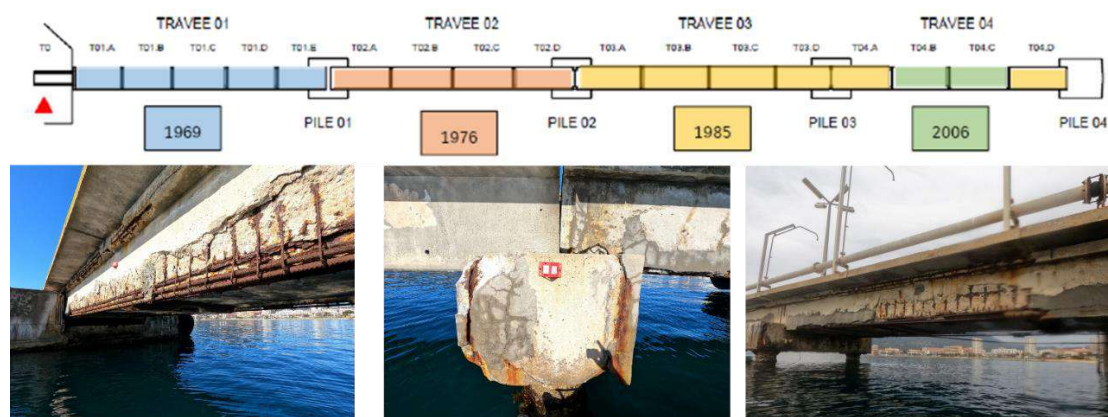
Plan des réfections réalisées sur l'apponement et photos des dégâts constatés (source MOA)
